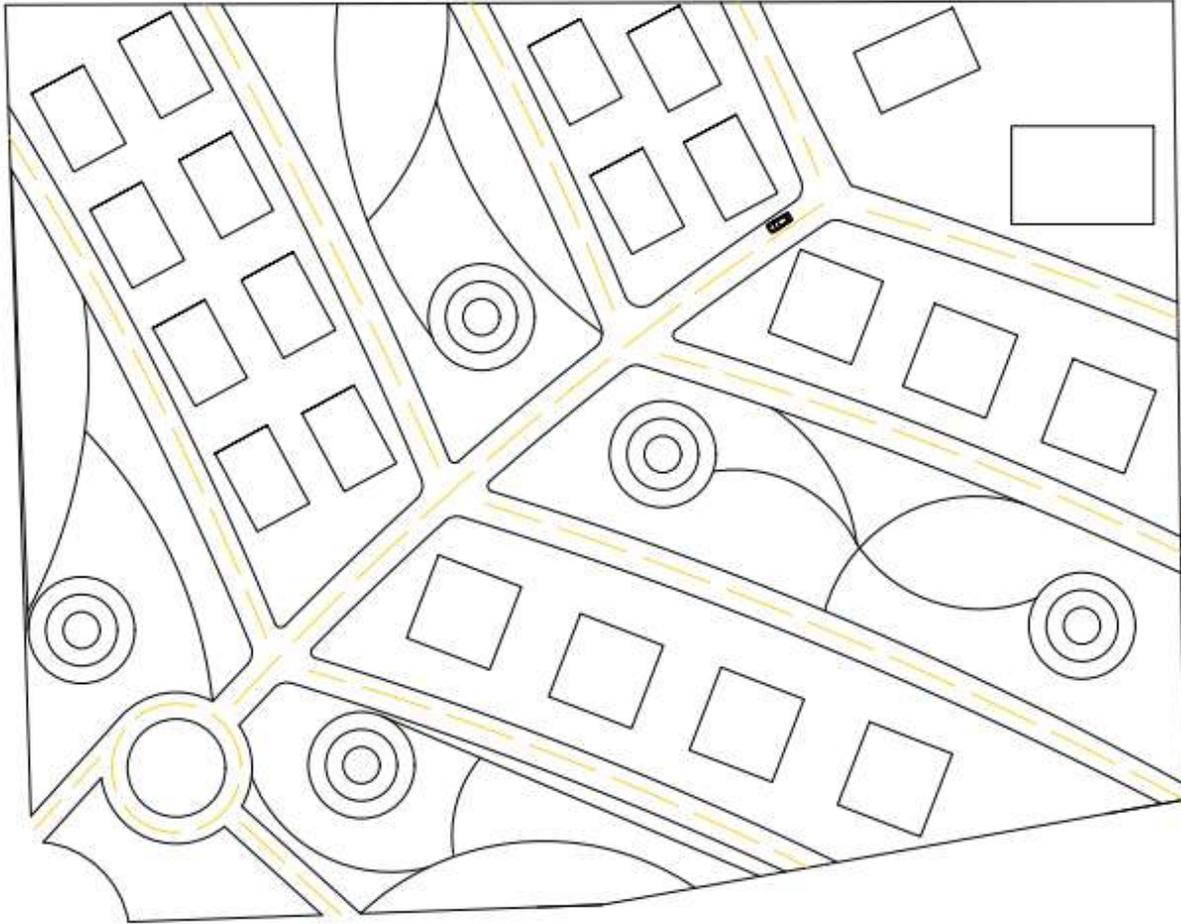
Primeras aproximaciones de viviendas y vegetación en el plano de conjunto
